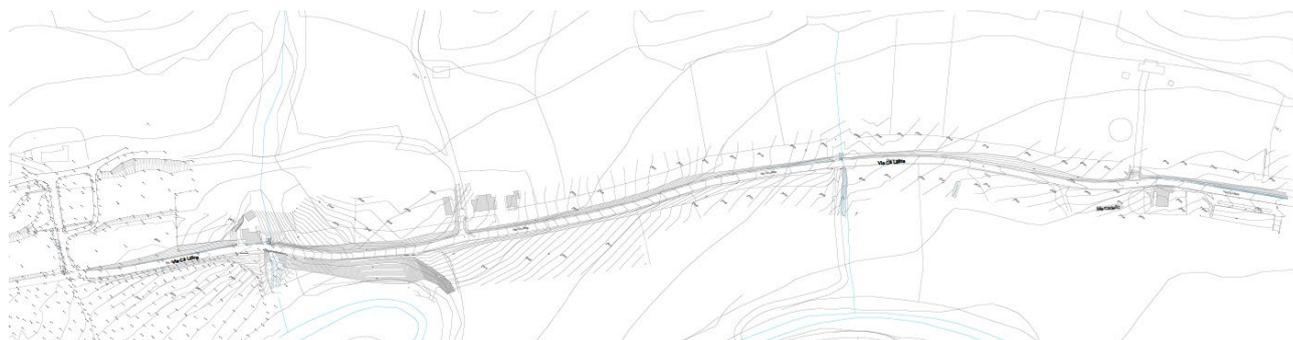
Planimetria imbocco Sud galleria Guinza (lato Umbria)
